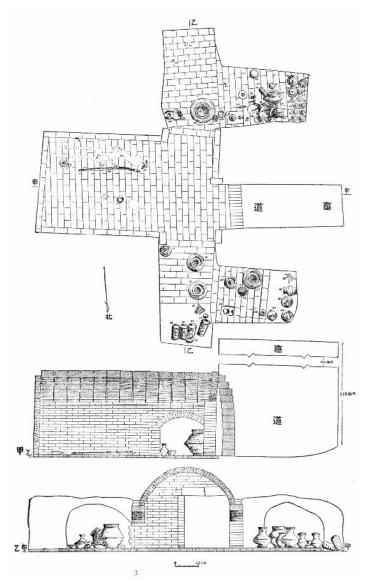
4 82 号墓 1、平面図 2、南縦断面図 3、西横断面図
